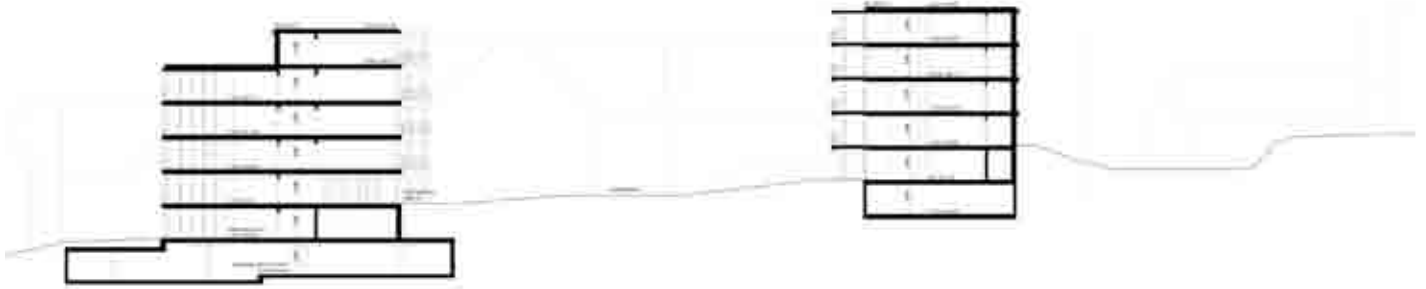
Woningbouwplan van de woonwijk 'De Nieuwe Wijk'.
